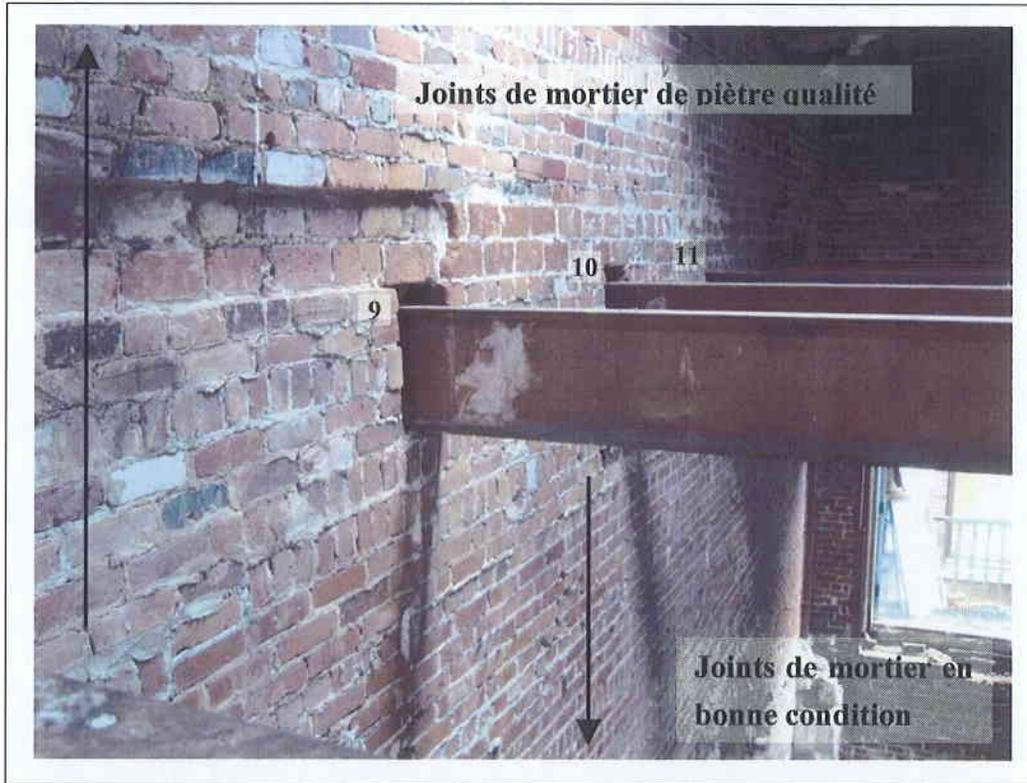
Poutres No. 9, 10 et 11. Même constat que la photo précédente: les joints de mortier au-dessus des poutres sont plus épais, poreux et inégaux.
